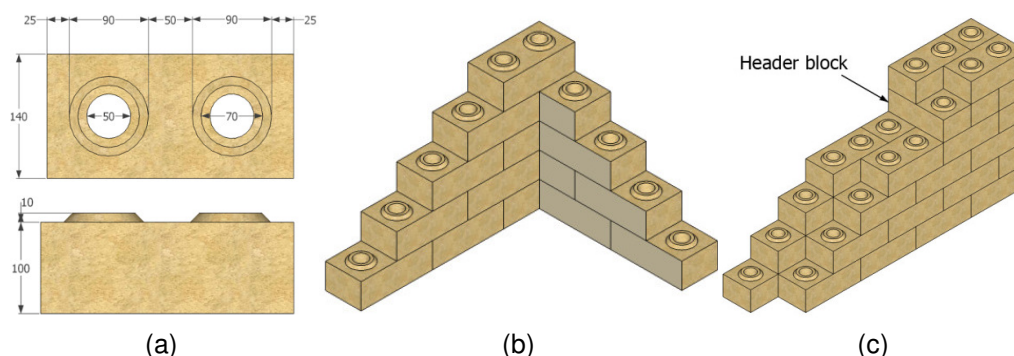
Sistema construtivo em BTC: (a) geometria do bloco (em mm); (b) parede simples; (c) parede dupla
